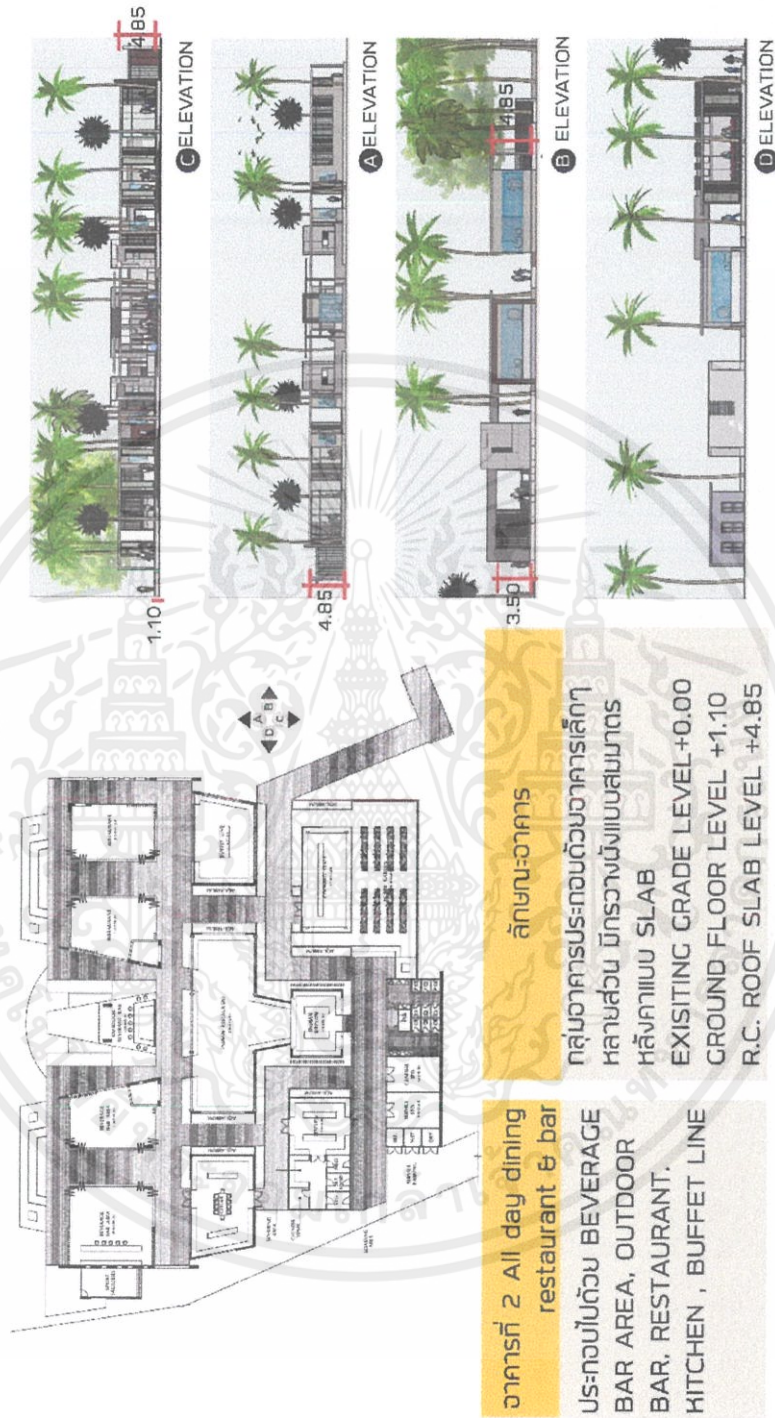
Elevation 3 restaurant (All day dining restaurant & bar)
